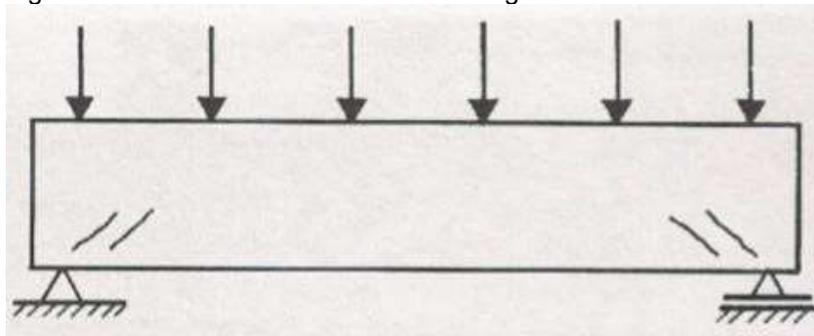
Fissura típica em viga solicitada à flexão
